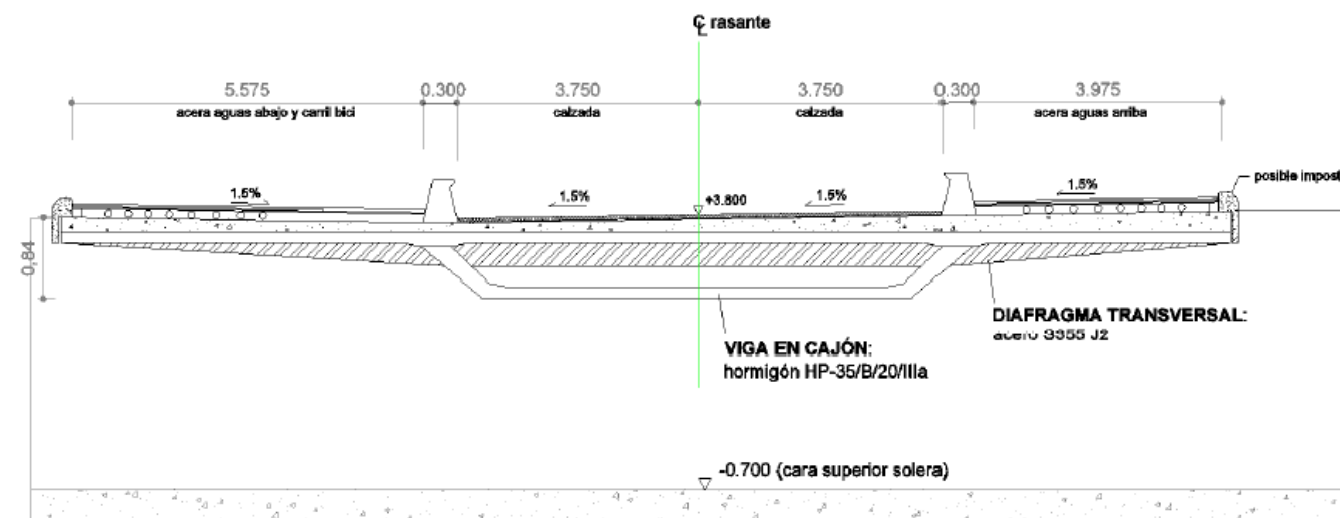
Propuesta B – Sección transversal del tablero en centro-luz
